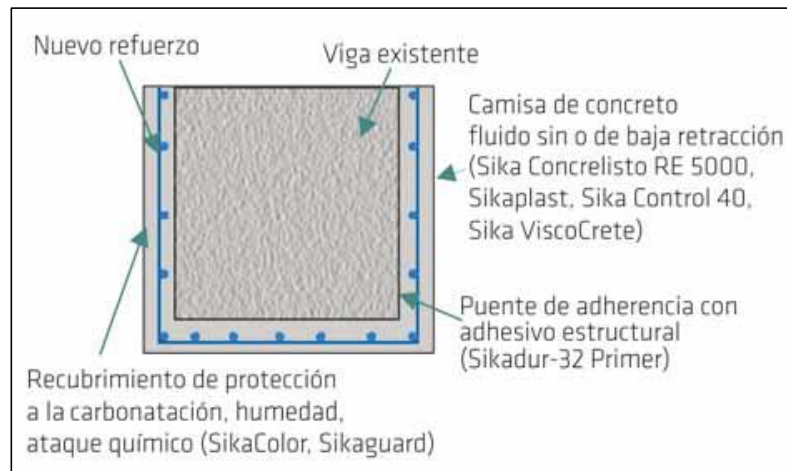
Recrido con concreto reforzado en vigas. Fuente: SIKA, 2017.
